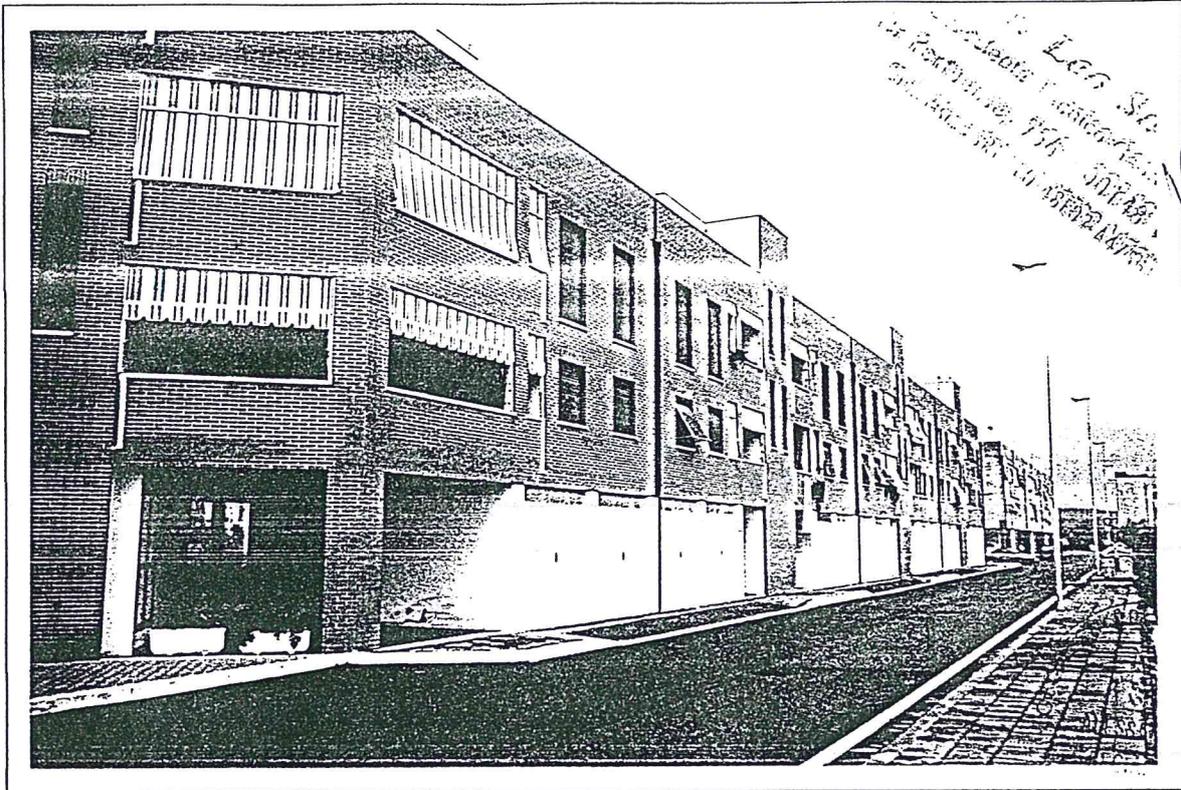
Prospetto Sud-Ovest. Fabbricato Via Mozart 17-19-21-23.
